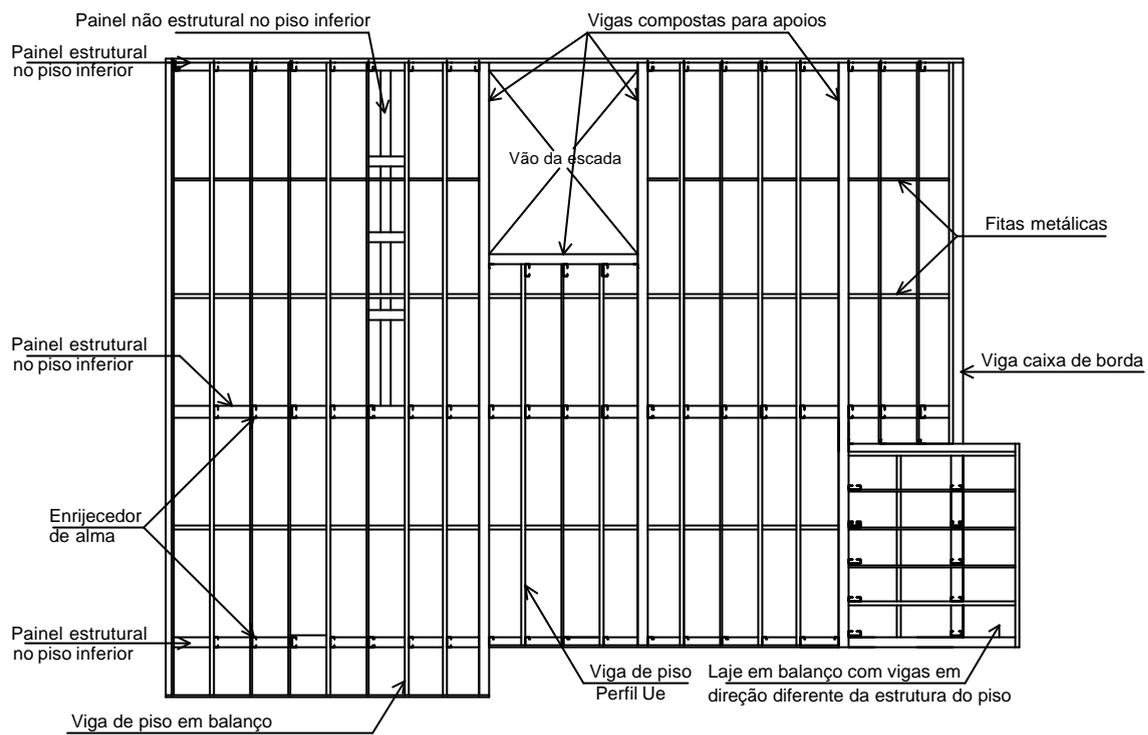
Planta de estrutura de piso em Steel Framing
